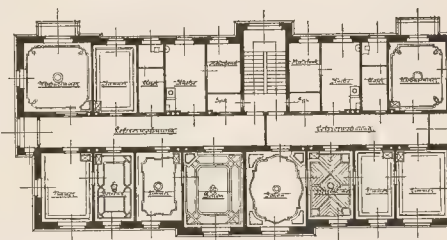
Grundrisse des nördlichen Lehrerhauses.
